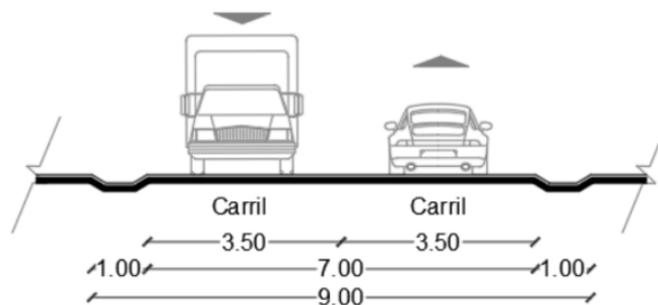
Distribución metros camino a Tecualtitán/ Sección F-F'
